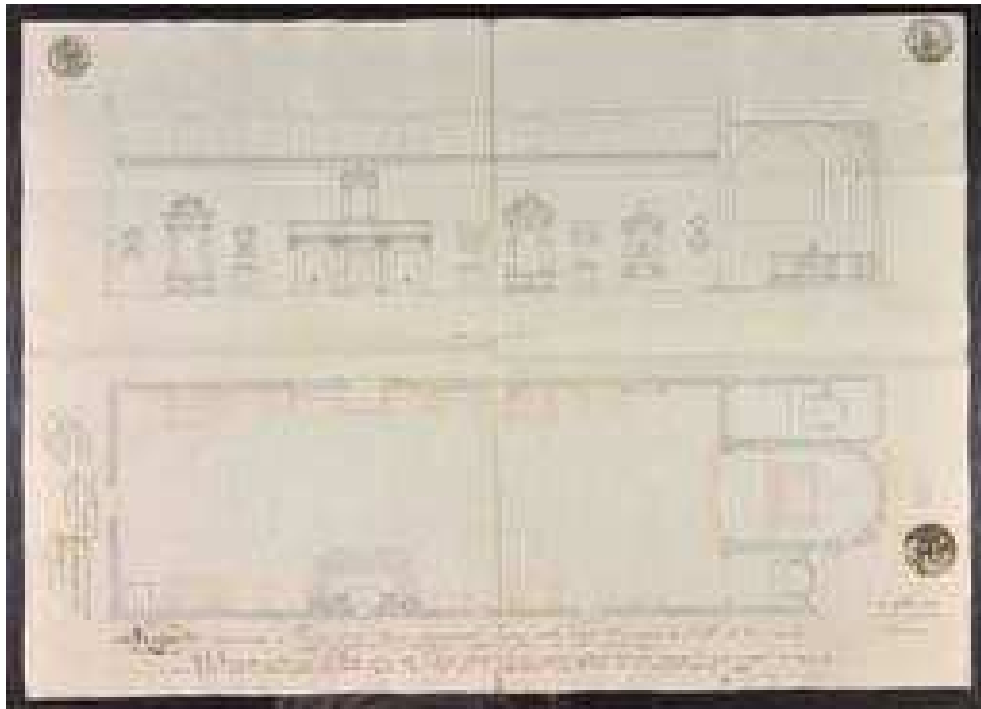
Sezione della parete est e planimetria della chiesa di Santa Maria dei Servi, 1837 (ASPd, Atti comunali - disegni, b. 1169, disegno 5).
